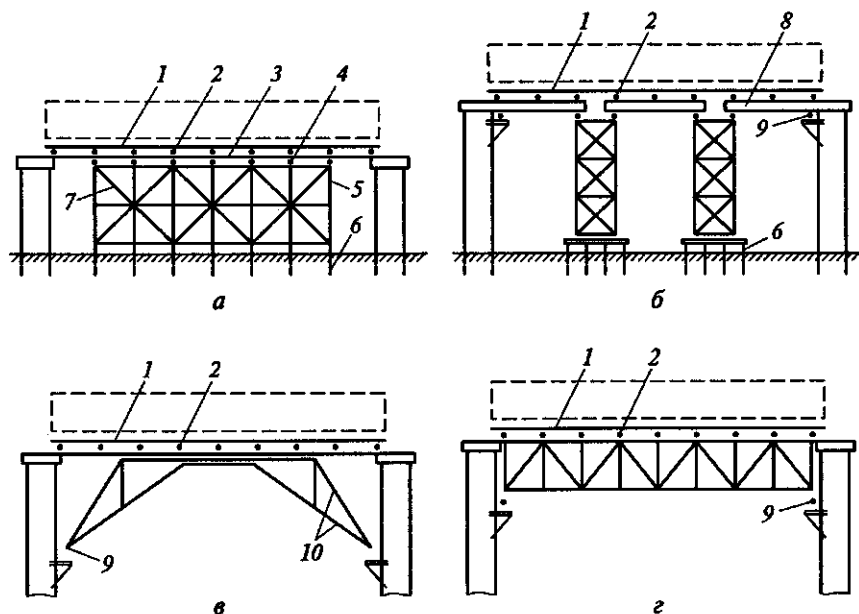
Подмости для устройства монолитных пролетных строений: а — стоечные; б — башенные; в — подкосные; г — ферменные; 1 — настил; 2 — поперечина; 3 — прогон; 4 — насадка; 5 — стойка; 6 — свая; 7 — продольные связи; 8 — балка; 9 — прибор для опускания; 10 — подкос
